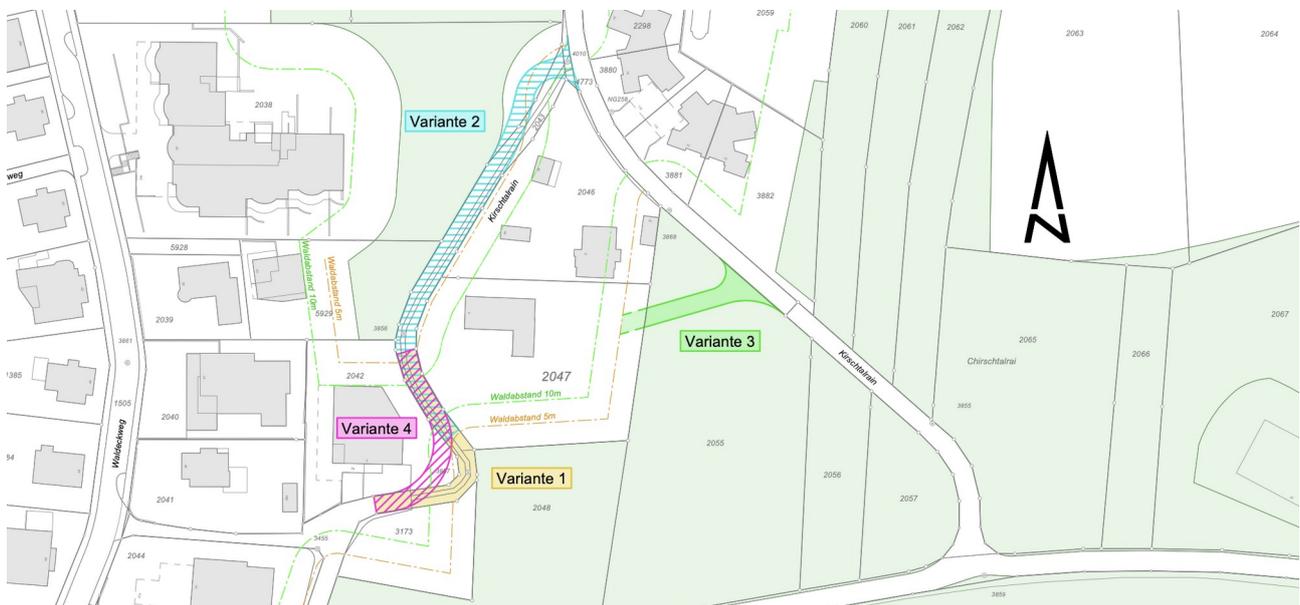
Erschliessungsvarianten. Quelle: Plan Jauslin Stebler AG vom 4. Mai 2023
